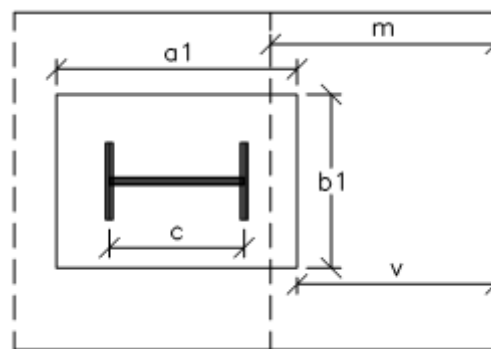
Vuelo de cálculo en una zapata con pilar metálico.
